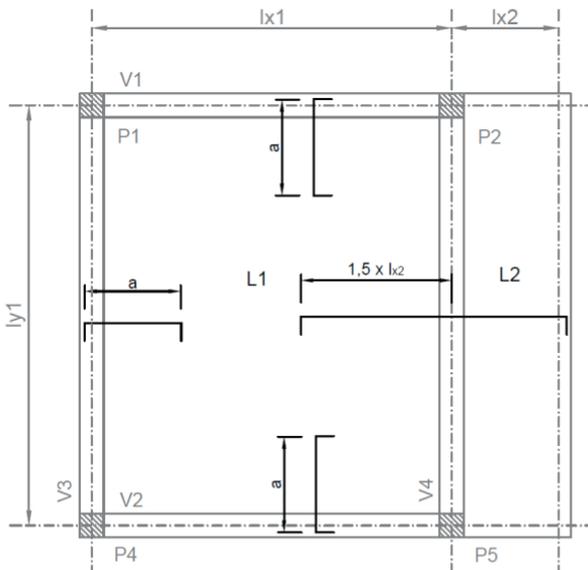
| Detalhe da armadura negativa (bordas e continuidade de laje)
